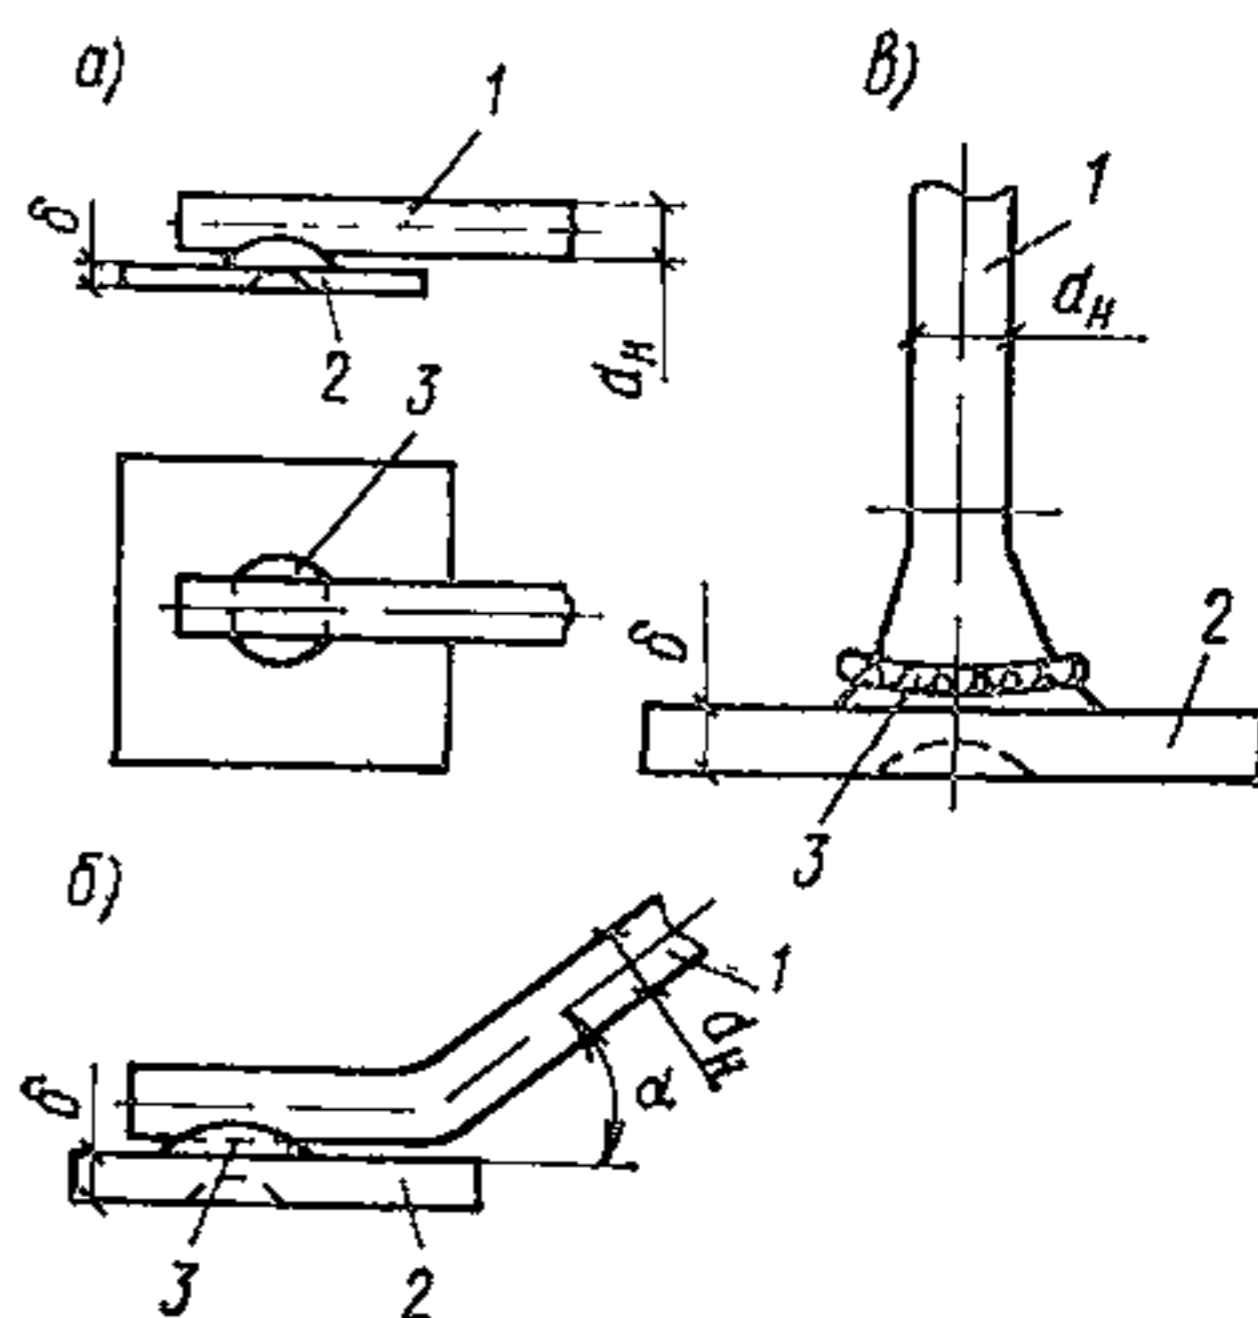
Конструкция соединения элементов закладных деталей при контактной рельефной сварке
